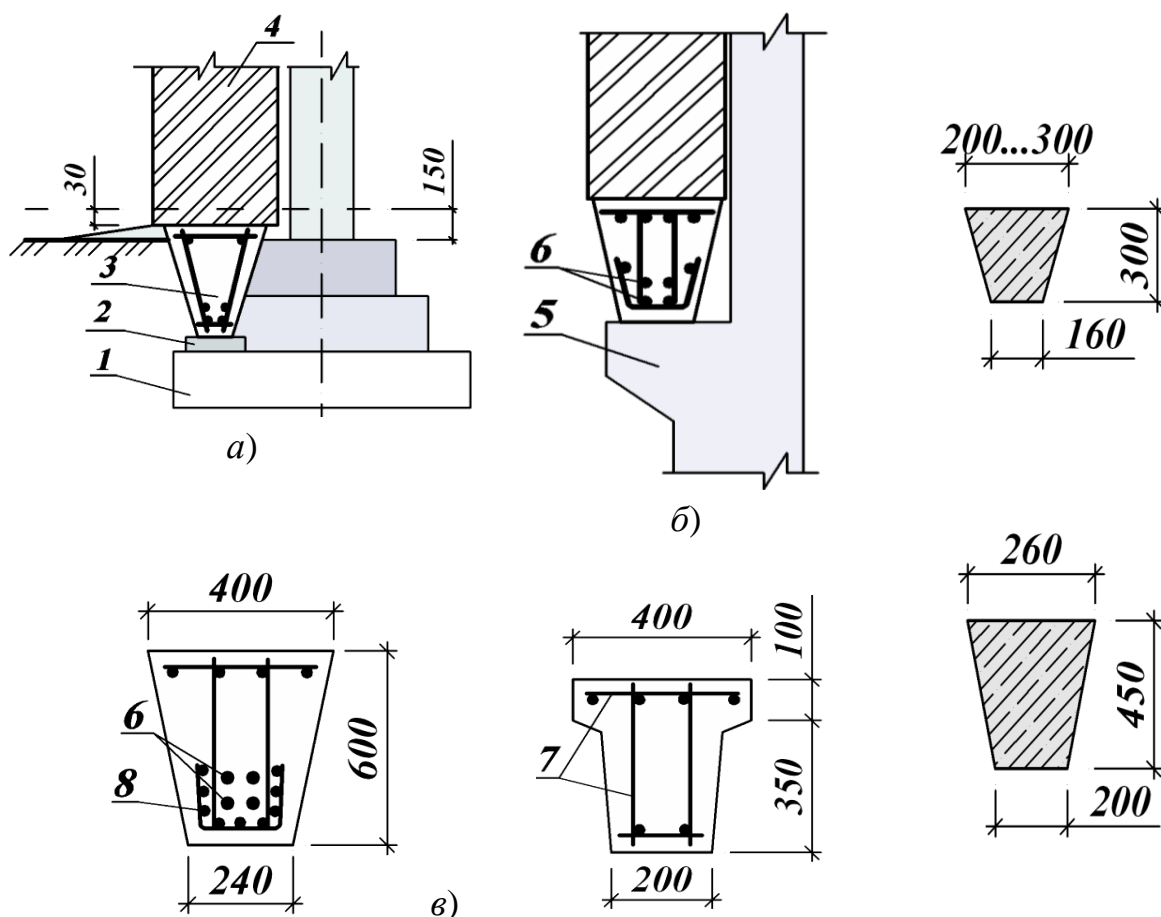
Фундаментні (*а*) та обв'язувальні (*б*) балки і їх поперечні перерізи (*в*):
